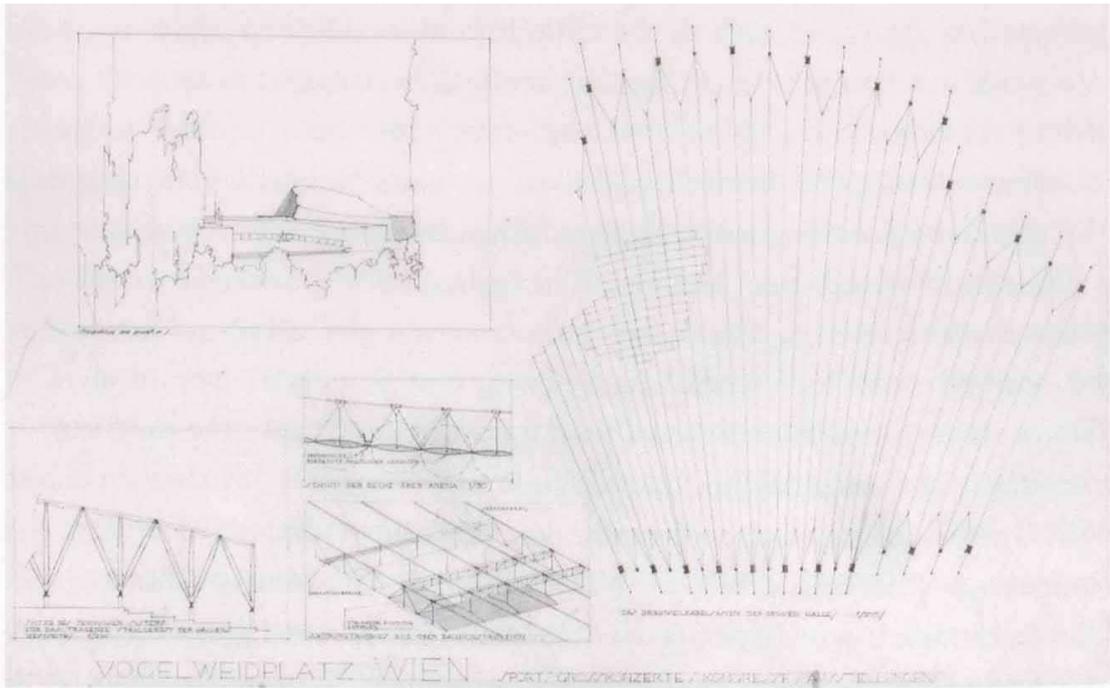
Dachkonstruktionen, Detailentwürfe
